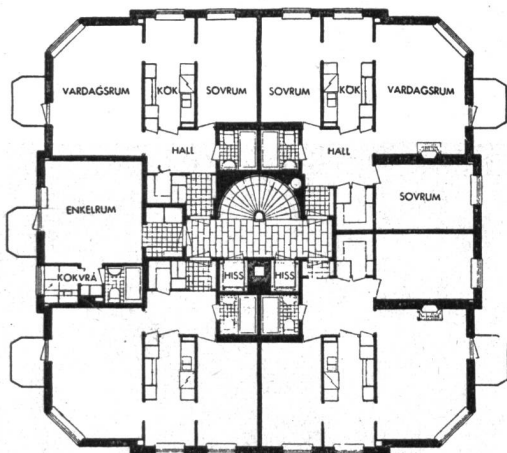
Grundriss einer Punkthaus-Etage von Danviksklippan. Zwei Dreizimmer-, zwei Zweizimmer- und eine Einzimmerwohnung mit zentralem Treppenhaus und im Kern konzentrierten Badezimmern. Begehbare Garderobenschränke. Küchen mit Fensteressplatz. In anderen Etagen auch Vier- und Fünzimmerwohnungen. Arch. Backström und Reinius.
